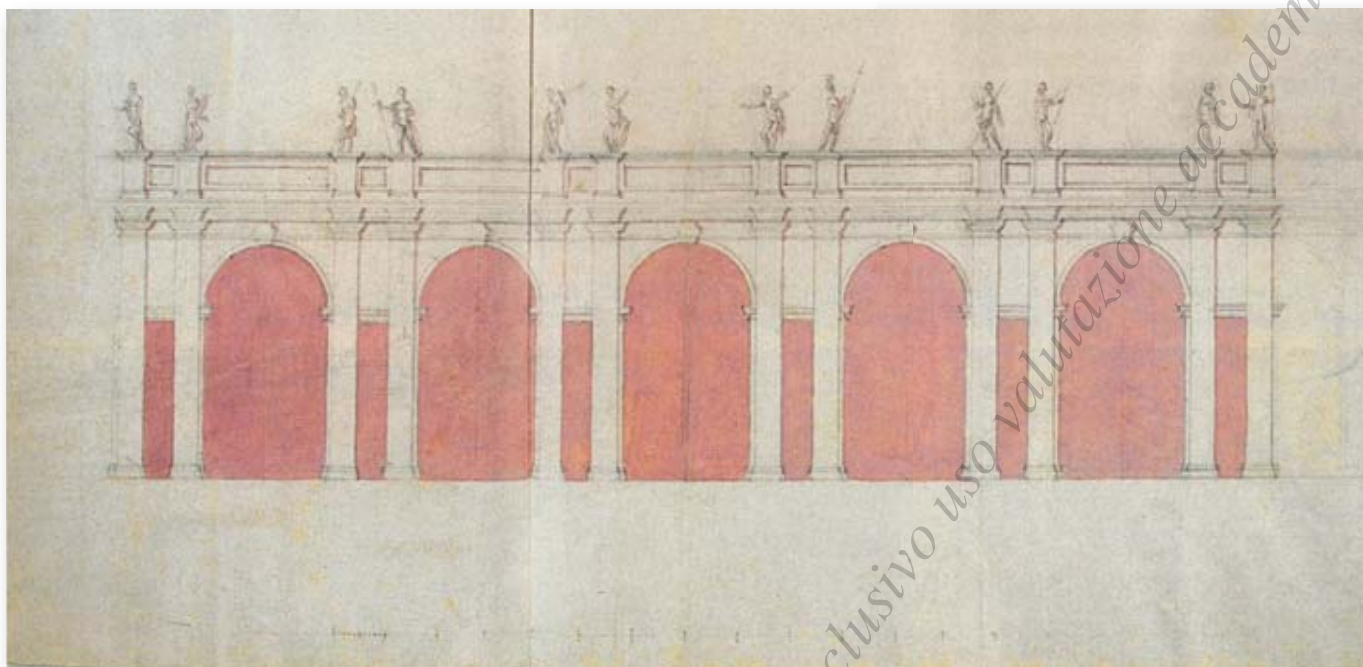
Virgilio Spada. Progetto per i portici retti di piazza S. Pietro. Prospetto (BAV, Chig., H. II 22, f. 94r). Sebbene anche di recente infondatamente attribuito alla bottega berniniana e riferito al terzo Braccio, il disegno è strettamente connesso ad un memoriale, di cui rappresenta la puntuale traduzione grafica, redatto da Virgilio Spada dopo il 20 settembre 1656 e presentato ad Alessandro VII il 31 dicembre successivo, in cui il padre Oratoriano critica il progetto del Bernini, avanzando una propria soluzione alternativa. La proposta delinea un prospetto impostato su archi di luce pari a 24 palmi e con altezza netta di poco inferiore "a doi quadri" (cioè il doppio della larghezza), alternati a vani minori architravati compresi tra le paraste binate distanti tra loro 6 palmi. La presenza dei varchi più stretti deriva da ragioni pratiche (possibilità da parte dei pedoni di attraversare i portici senza "essere impediti da carrozze") e da motivazioni estetiche ("Aggiungo ch'essendo questi piccoli vani di transito, coperti da un'architrave in piano, il dritto di questi col curvo degli archi, mi pare apportarebbe quel più di bellezza, che desiderare si possa in cosa tale"). All'articolazione nel prospetto con archi ed elementi trabeati corrisponde nei vani interni un doppio sistema voltato (volte a crociera nel primo caso, a botte nel secondo) che, secondo lo Spada, "farebbe belliss.o vedere a chi camminasse sotto d.i portici". Il disegno manifesta peraltro diversi solecismi, come la sgrammaticata sproporzione dell'altezza della trabeazione rispetto a quella delle paraste (addirittura 1/10) e la sciatta ed improbabile articolazione degli archivolti
